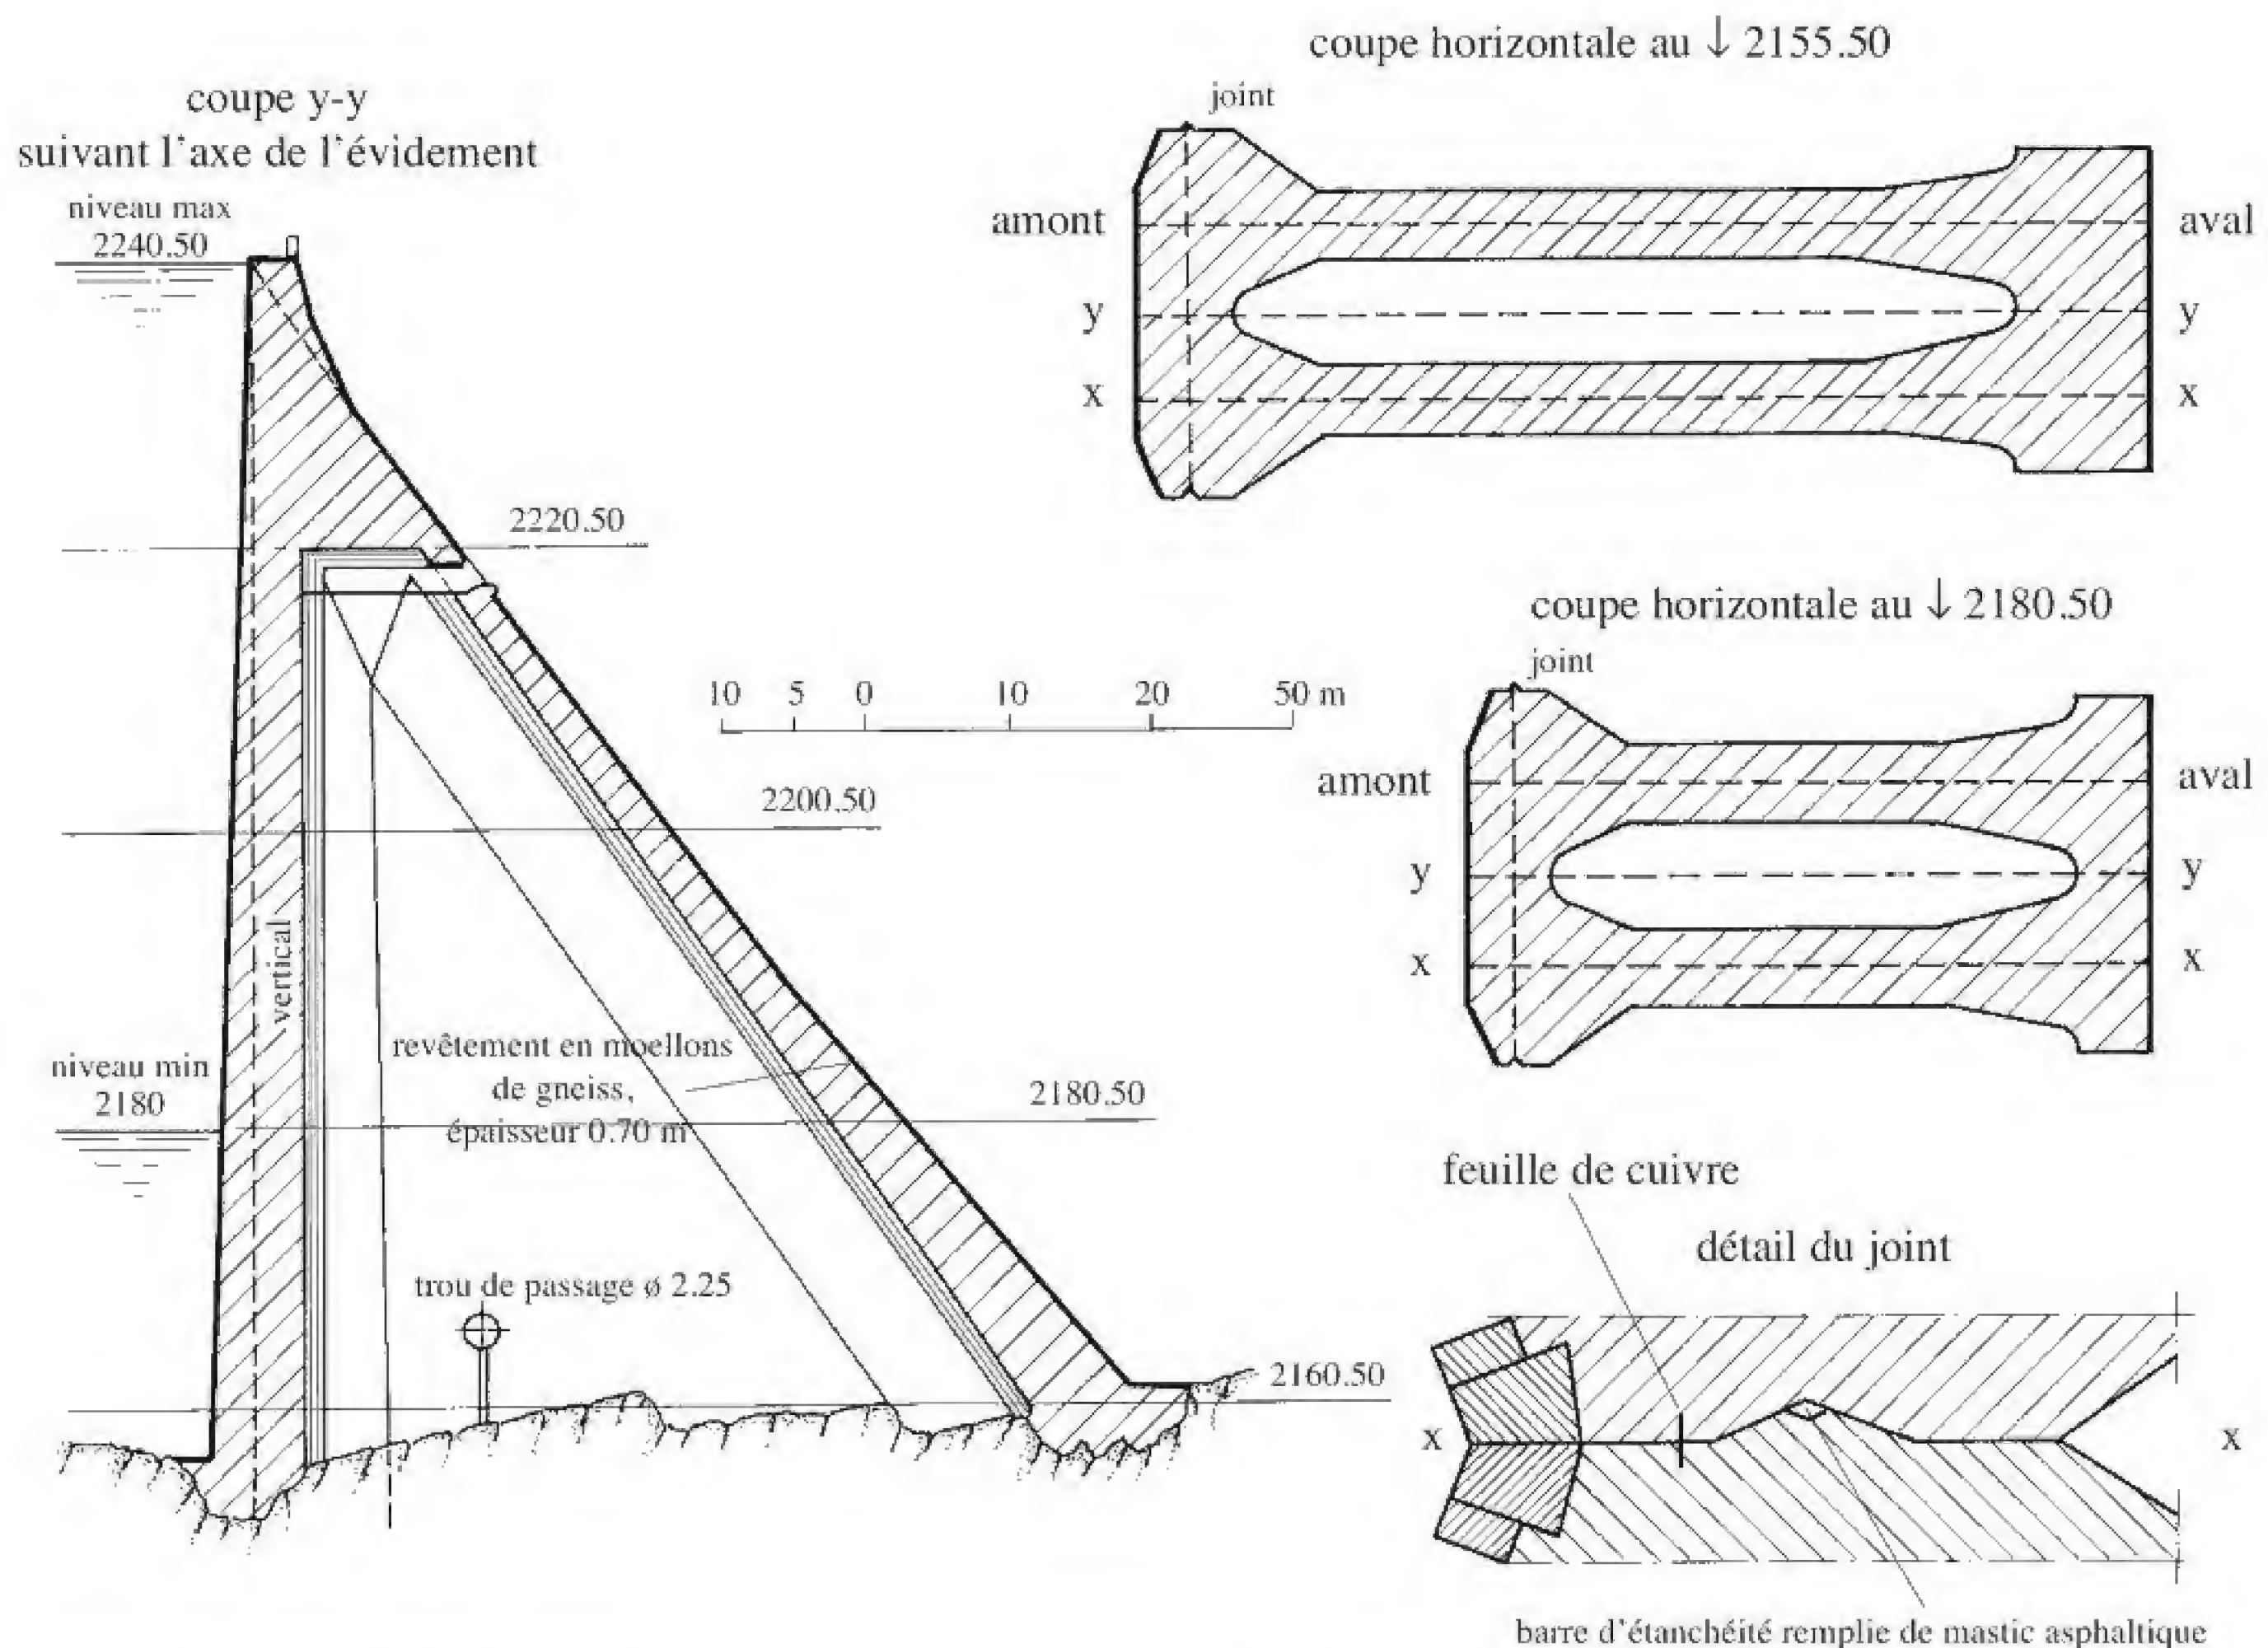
Coupes transversale et horizontales du barrage de la Dixence, premier barrage-poids évidé construit en Suisse (tiré de BTSR, 72^e année, 16 février 1946, N° 4, Le barrage de Dixence, A. Stucky, p. 42).
